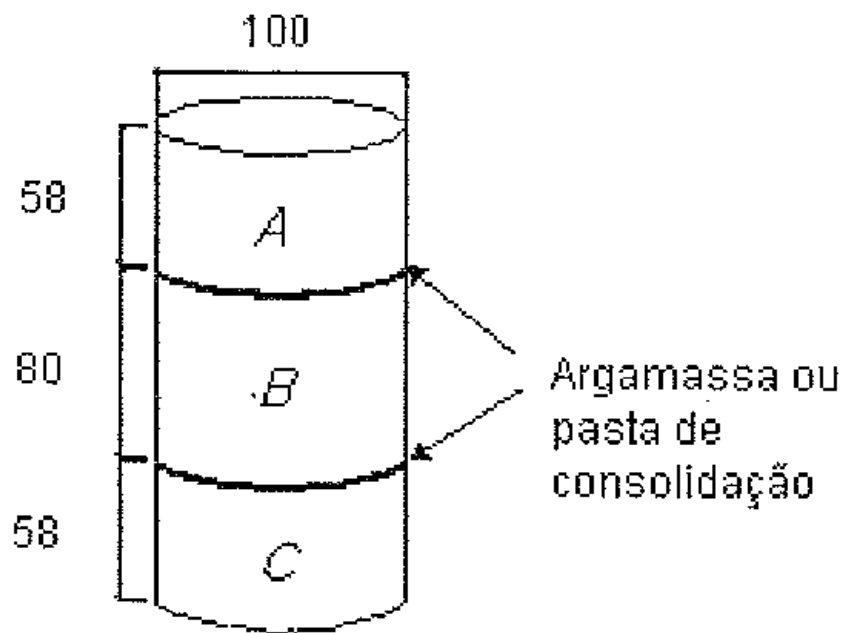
Esquema de montagem do corpo-de-prova tipo III - Dimensões em milímetros
